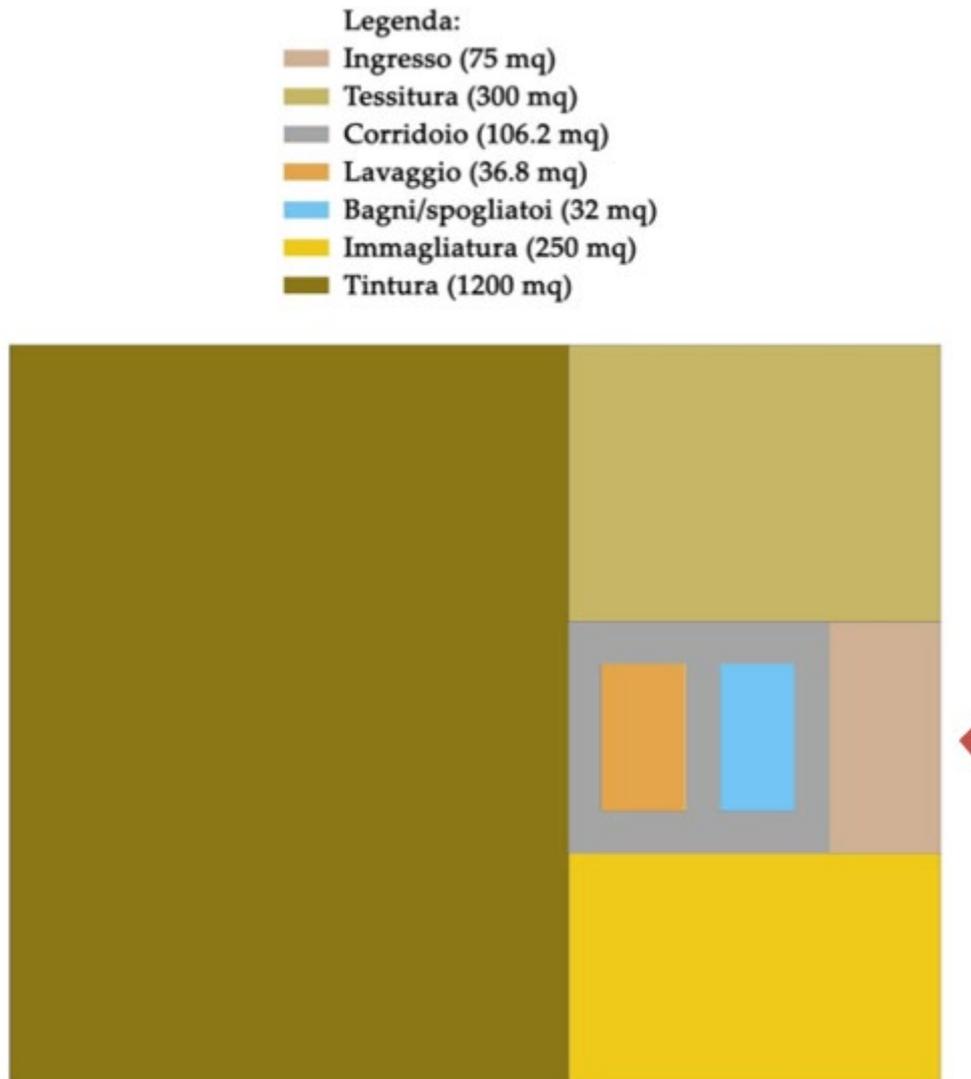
Legenda e planimetria schematica dell'industria tessile proposta.
